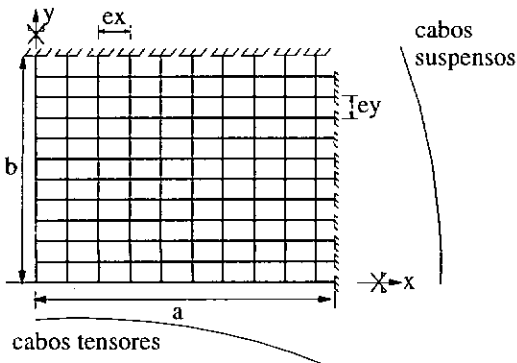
a Projeção em planta de $1/4$ da malha de cabos
